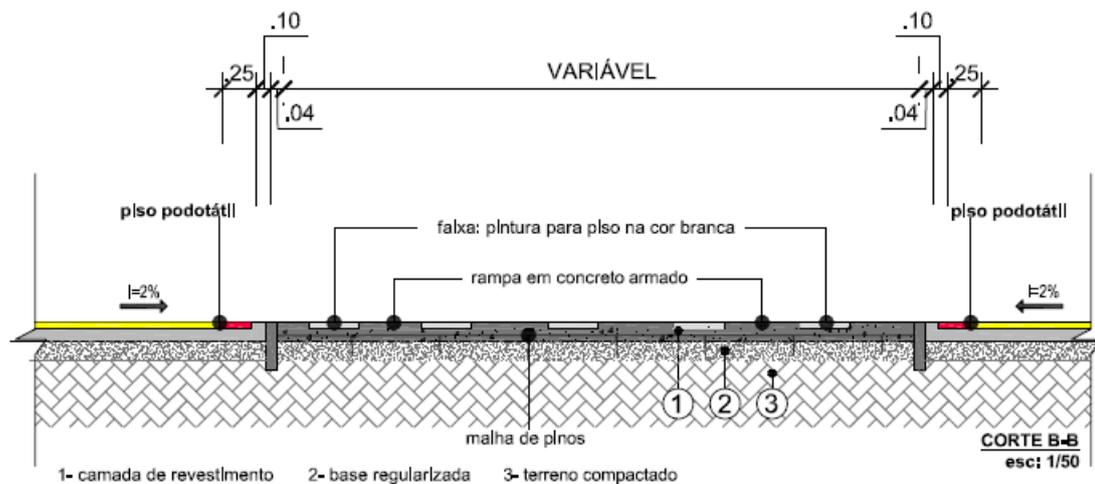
Detalhe construtivo em corte transversal da faixa elevada
